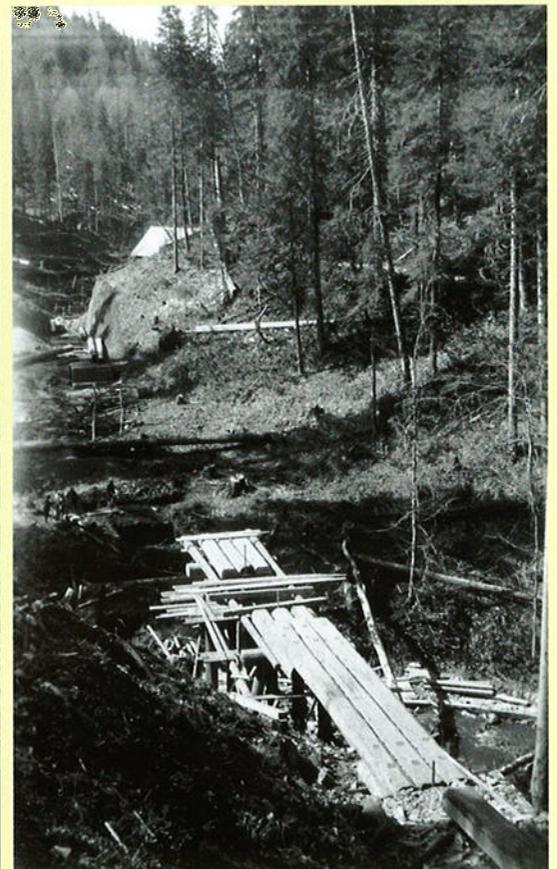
Waldbahnbrücke aus Holz im Bau (F. Hafner)
